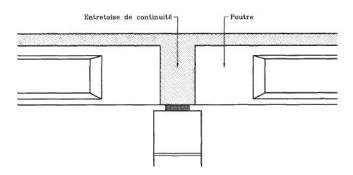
Coupe longitudinale sur appui d'un tablier à poutres à travées continues
